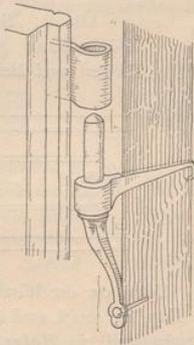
Beschlag. Stützhaken, in Holz einzuschlagen.
